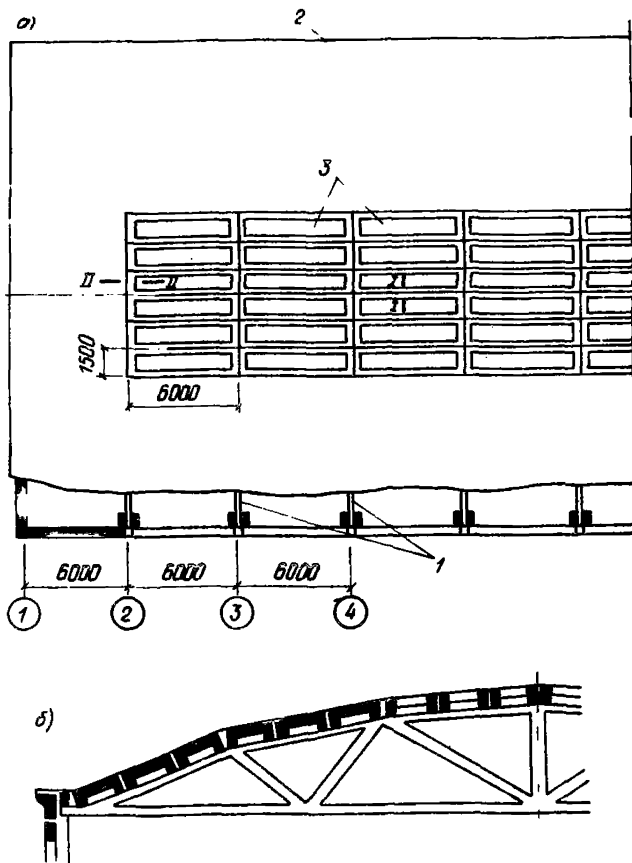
Освещение верхним светом производственного помещения при помощи стекложелезобетонных панелей покрытия
